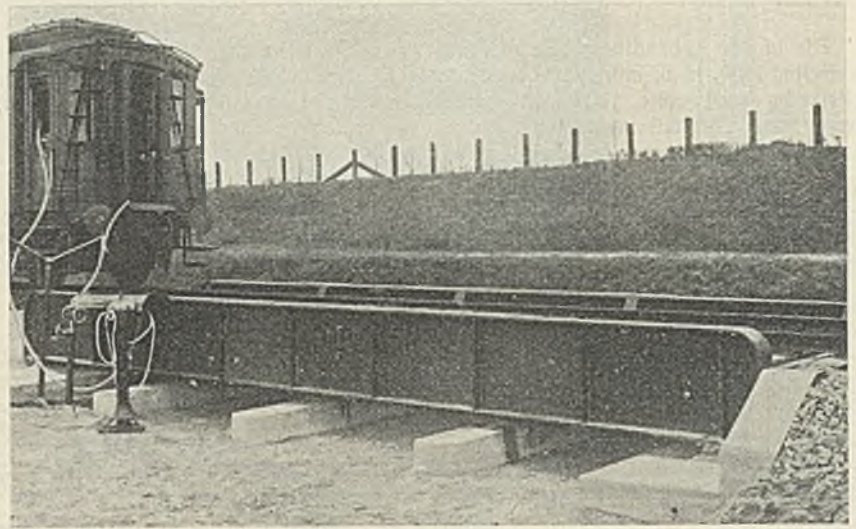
Röntgenuntersuchung der Schweißnaht der oberen Gurtung der eingebauten Brücke.
